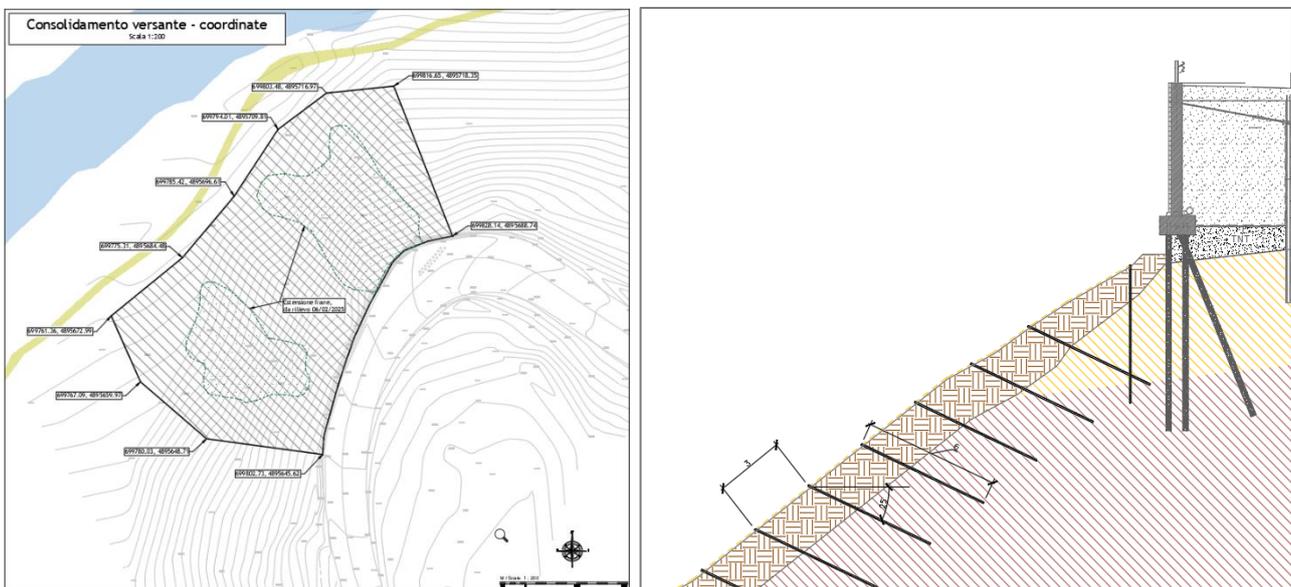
Opera di progetto, sinistra: planimetria; destra: sezione tipo
